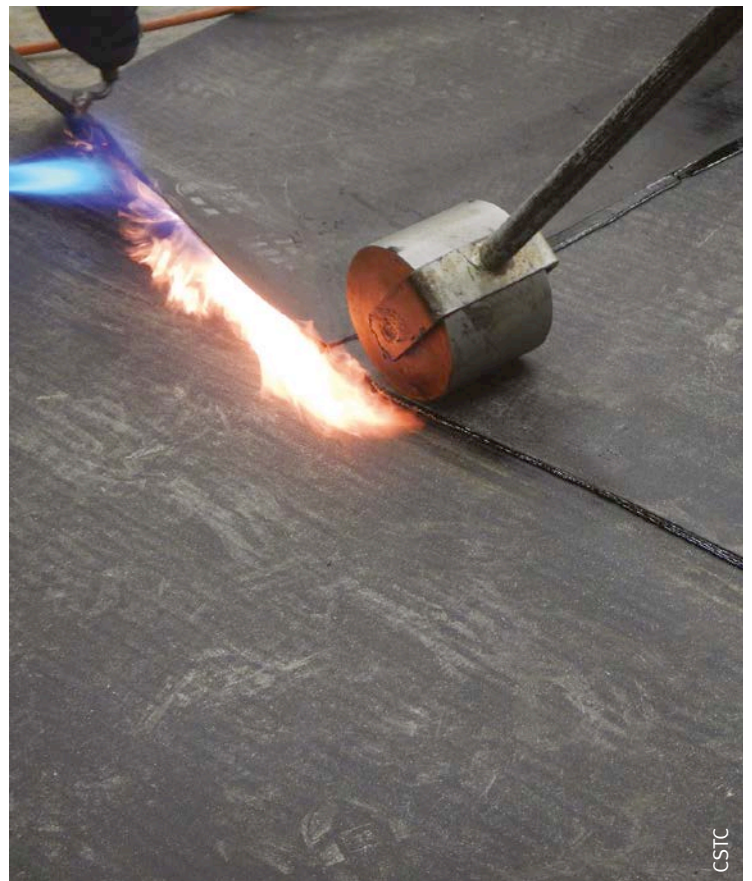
Joint de membrane bitumineuse soudé et pressé au rouleau.
